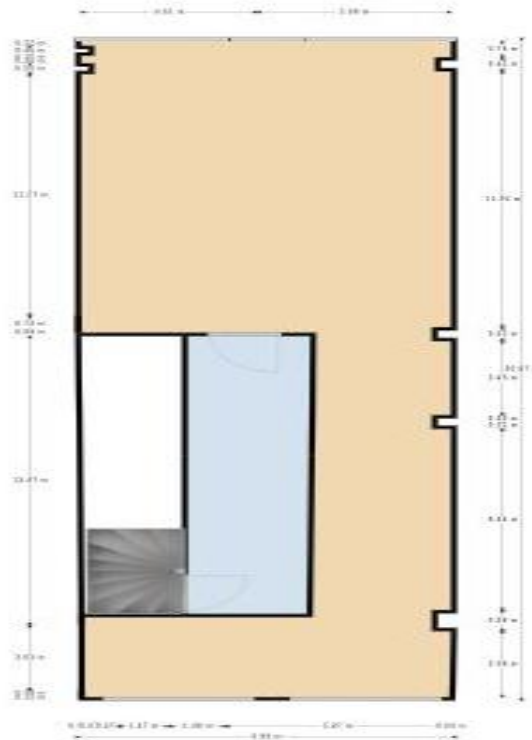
Layout planta de fabricación conforto Mas, elaboración propia.
